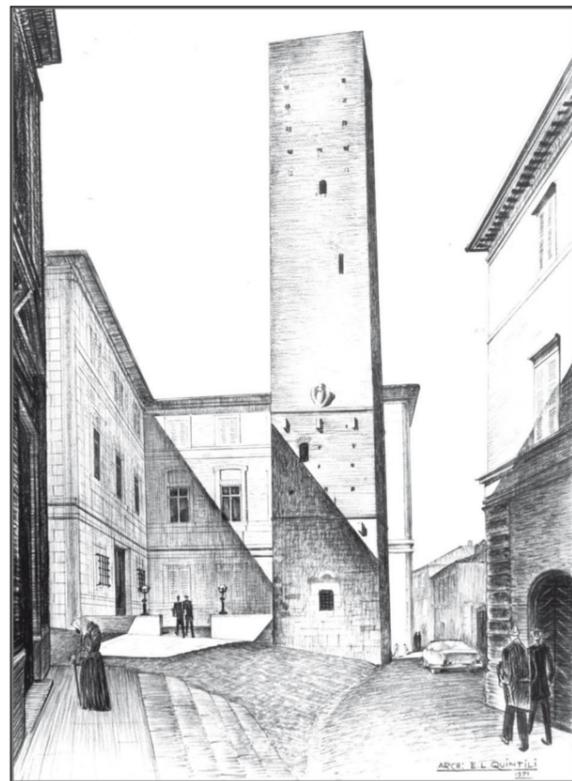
Proposta progettuale dell'architetto Quintili. Prospetto sulla piazzetta antistante la chiesa del Carmine.
